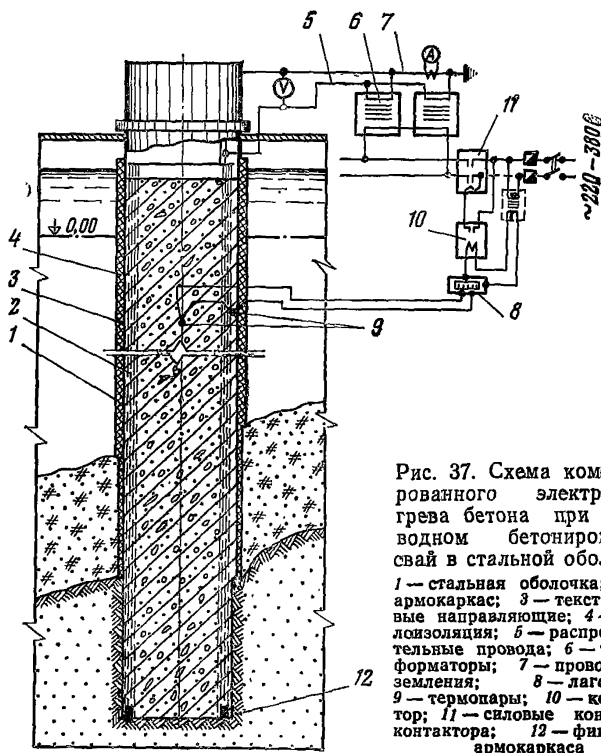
Схема комбинированного электропрогрева бетона при подводном бетонировании свай в стальной оболочке
